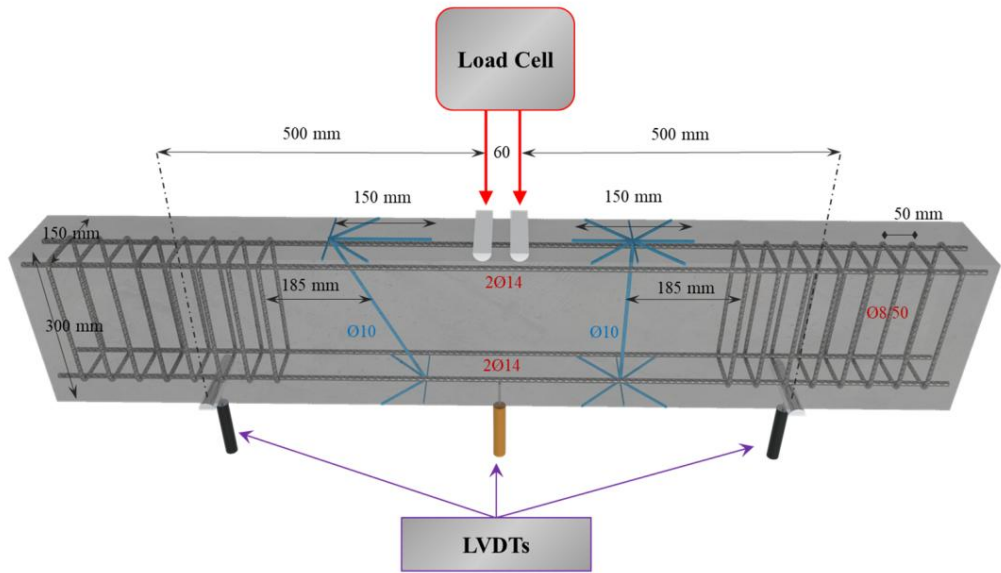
Detalles de geometría y refuerzo de la viga R-Deep Beam.
